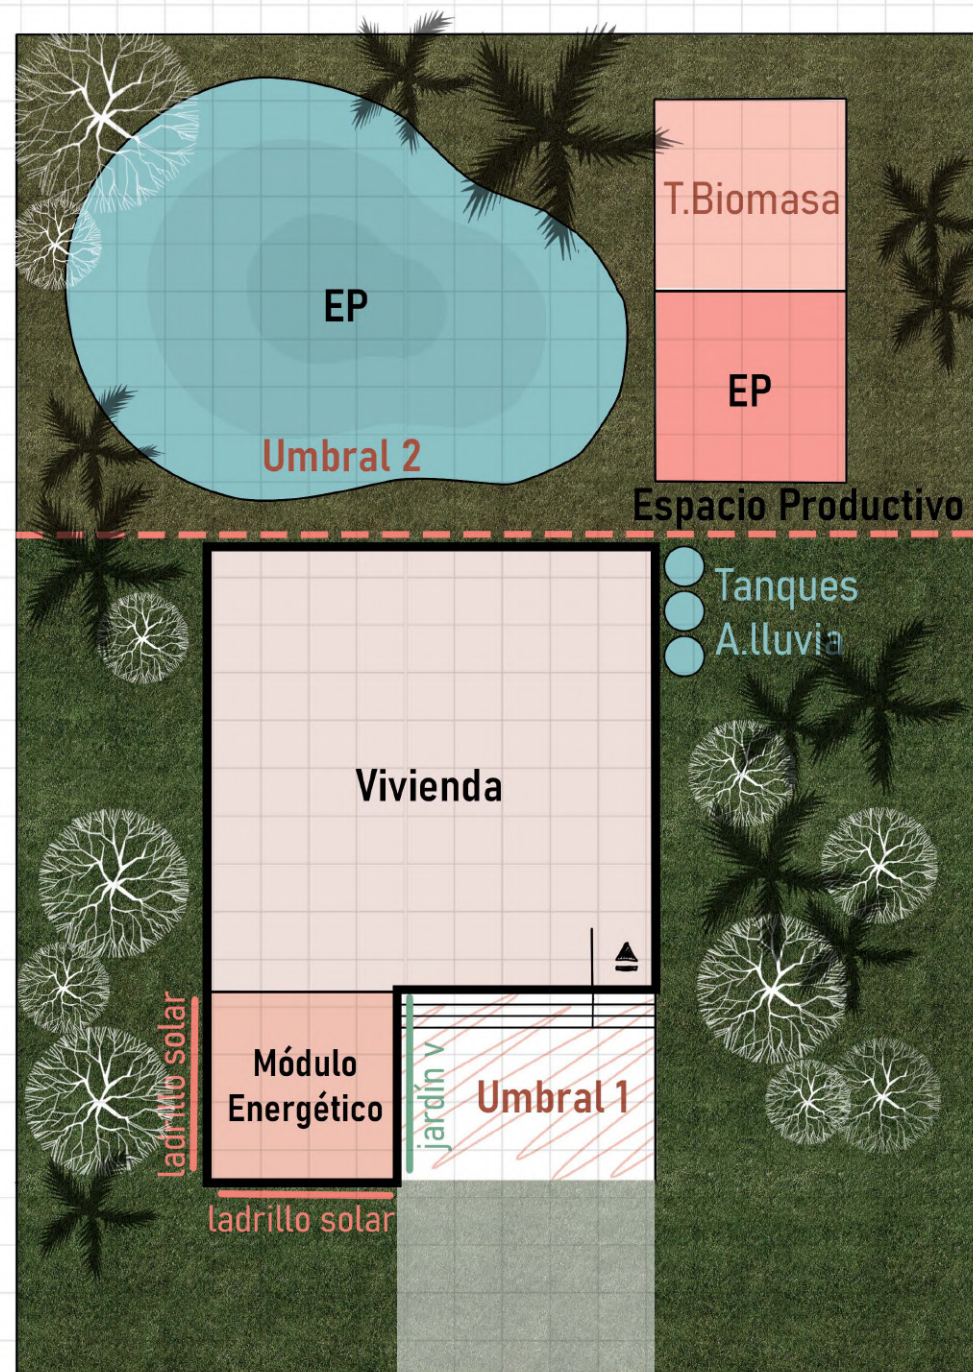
Planta esquemática de la propuesta para la vivienda en el barrio El Túnel. Elaboración propia.
